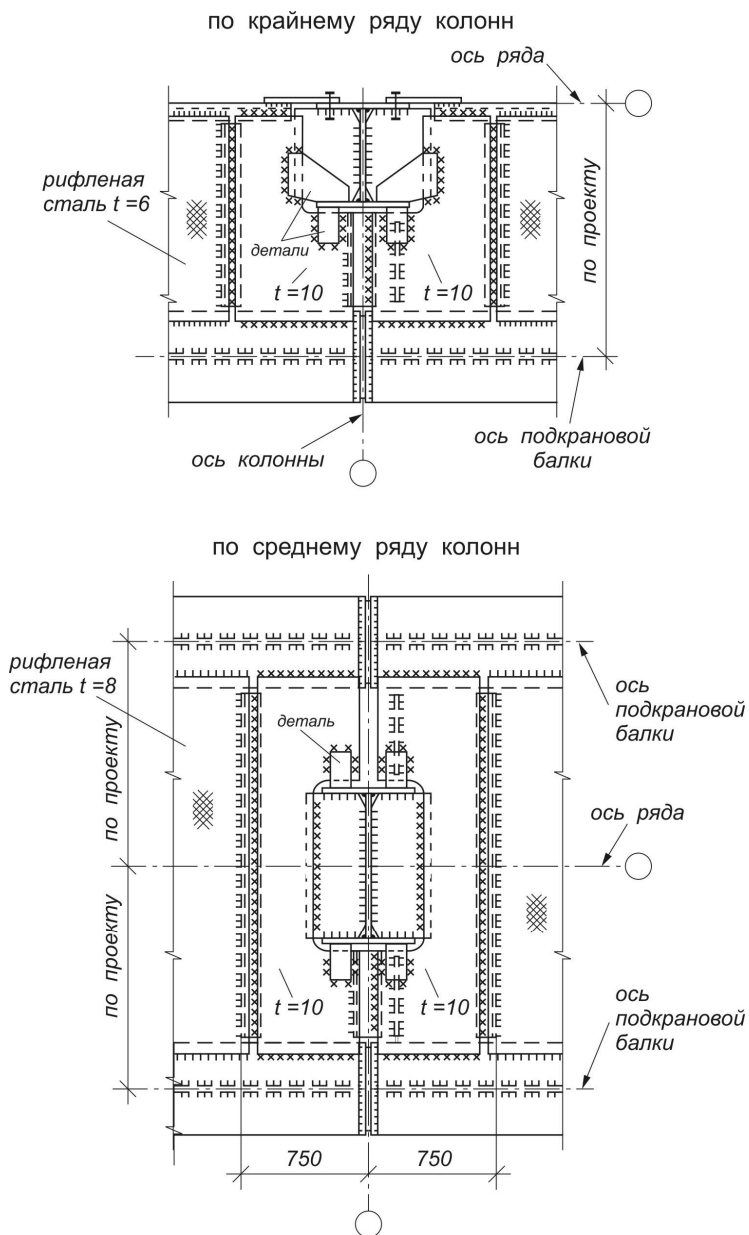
Сопряжение разрезных подкрановых конструкций в уровне верхнего пояса при тормозной балке
